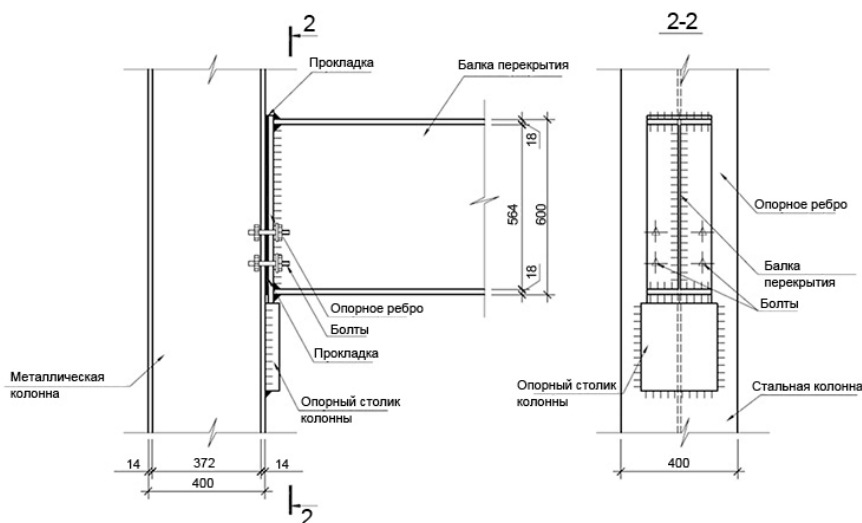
Типовой узел сопряжения колонны и перекрытия в металлическом каркасе
